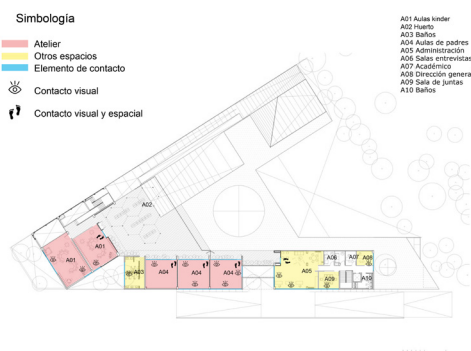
Planta arquitectónica segundo nivel Preescolar Beelieve
